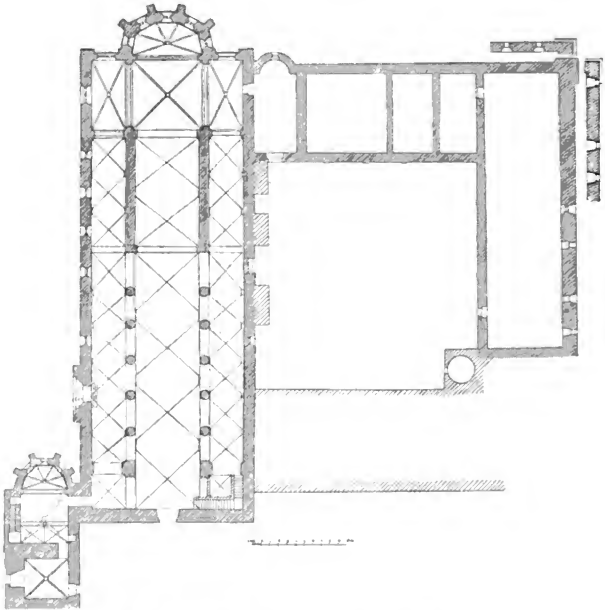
Mühlhausen. Grundriss der Kirche und des Klosters.
